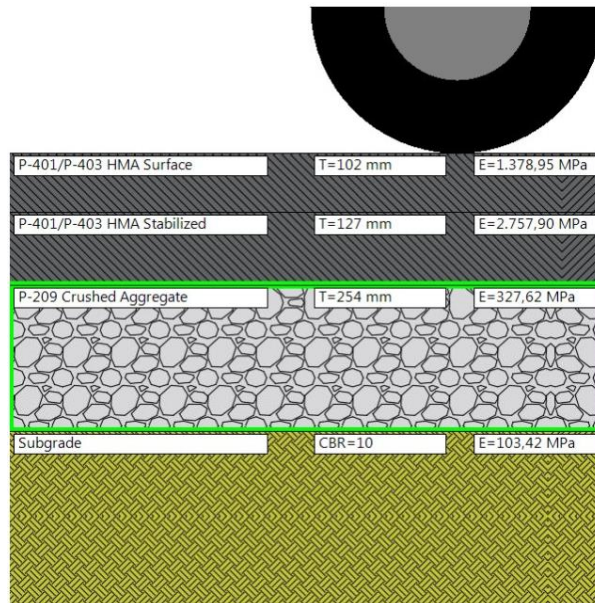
Estructura de pavimento flexible estándar adoptada por FAARFIELD 2.0.
